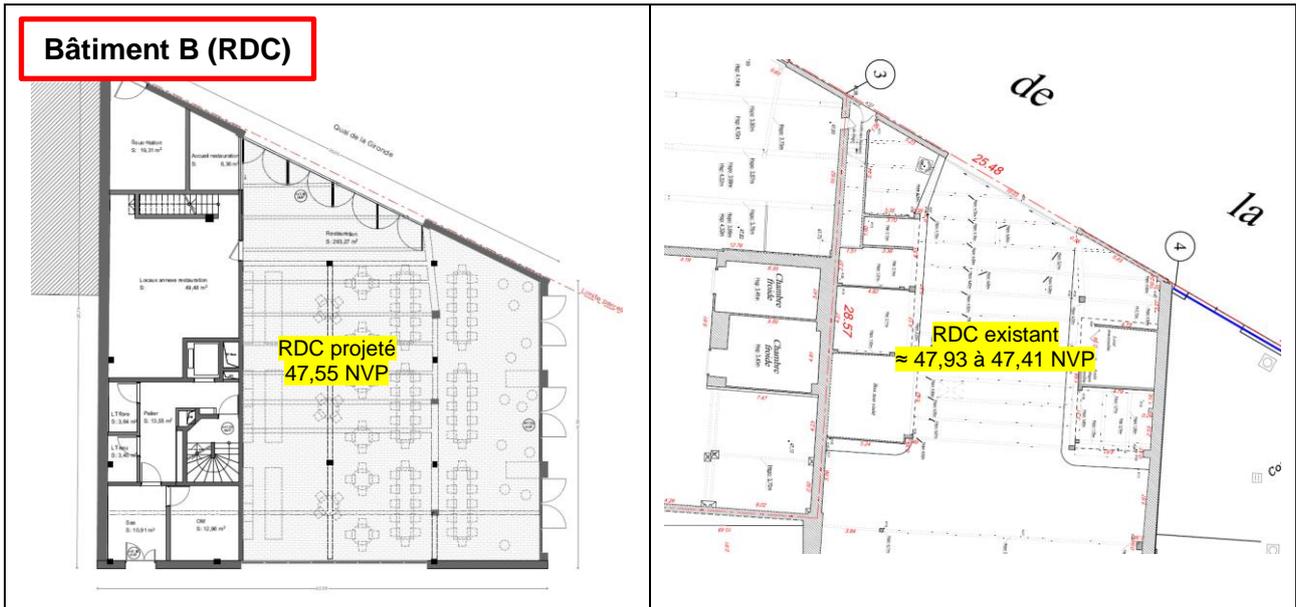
Extrait du plan RDC du bâtiment B, daté du 17/11/2023 et extrait du plan RDC existant du 12/04/2023
